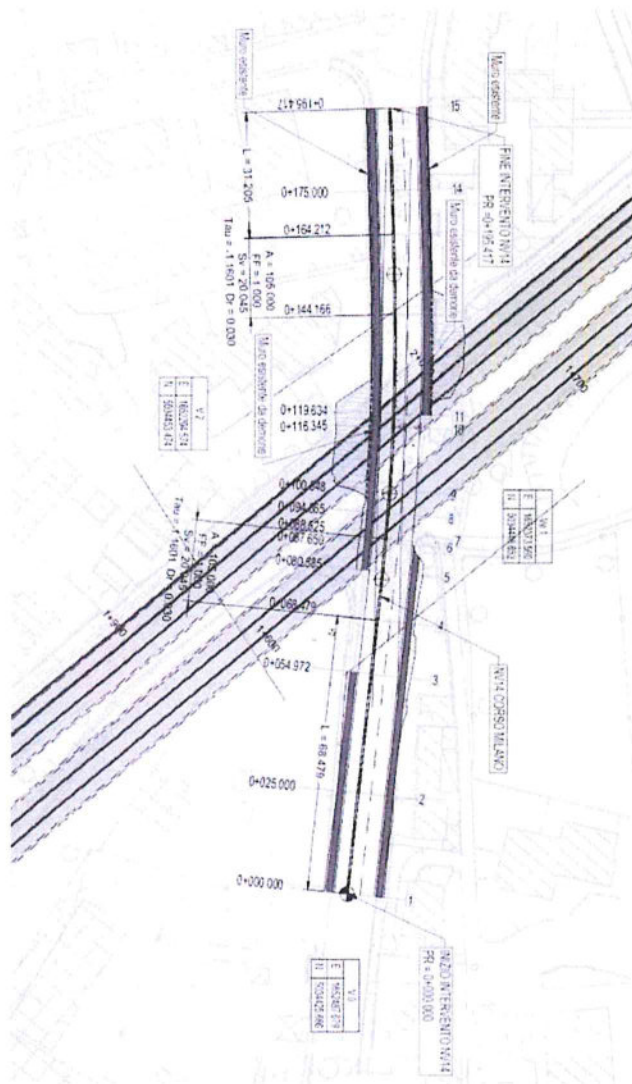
NV14 – Stralcio planimetrico su rilievo Corso Milano
